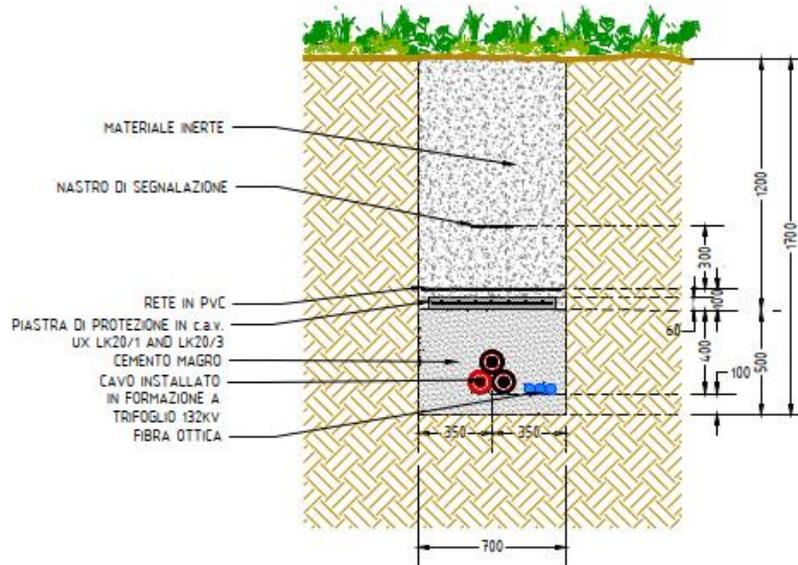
Sezione tipo su terreno - Tratto di cavidotto dalla SE di Trasformazione alla SE di Connessione.
